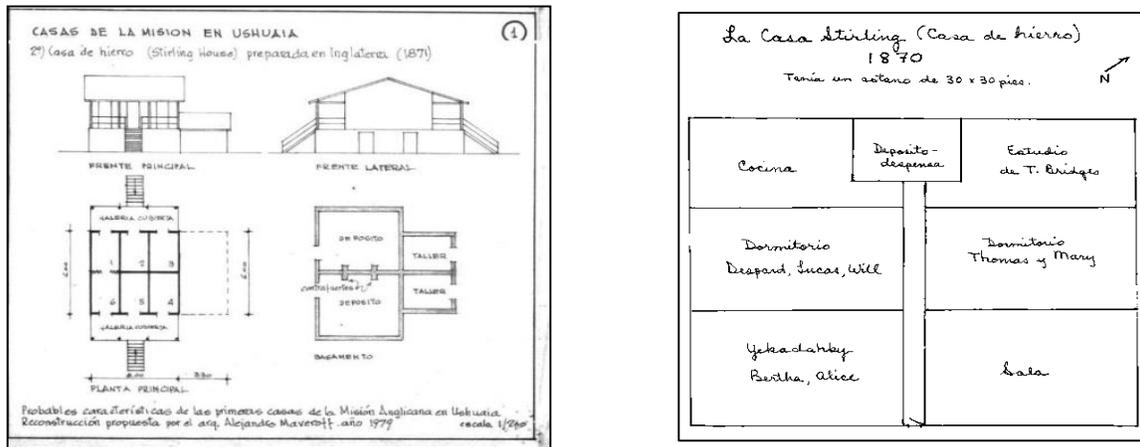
y 24. (Izq.) Casa de la Misión. Reconstrucción Fuente: Arq. Maveroff año 1979. (Der.) Plano de la casa Stirling utilizada por Bridges entre los años 1871 y 1886. Fuente: Denis Chevally
